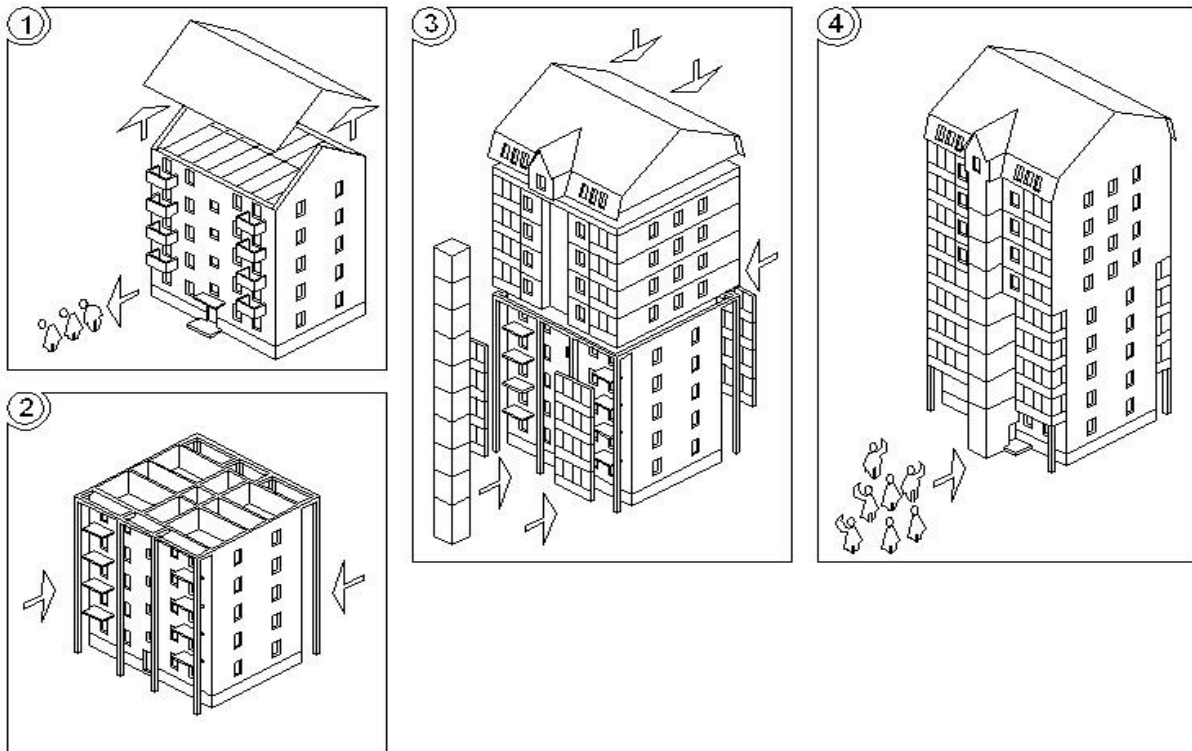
Стадии реновации, осуществляемой с надстройкой дополнительных этажей и мансарды (рисунок Н. Грекова): 1 – расселение жильцов, демонтаж старых сетей, демонтаж кровли и конструкций крыши; 2 – возведение независимых опор и горизонтальных несущих конструкций; 3 – монтаж верхних этажей и мансарды; 4 – монтаж инженерных сетей, перепланировка и ремонт старых квартир, заселение жильцов
